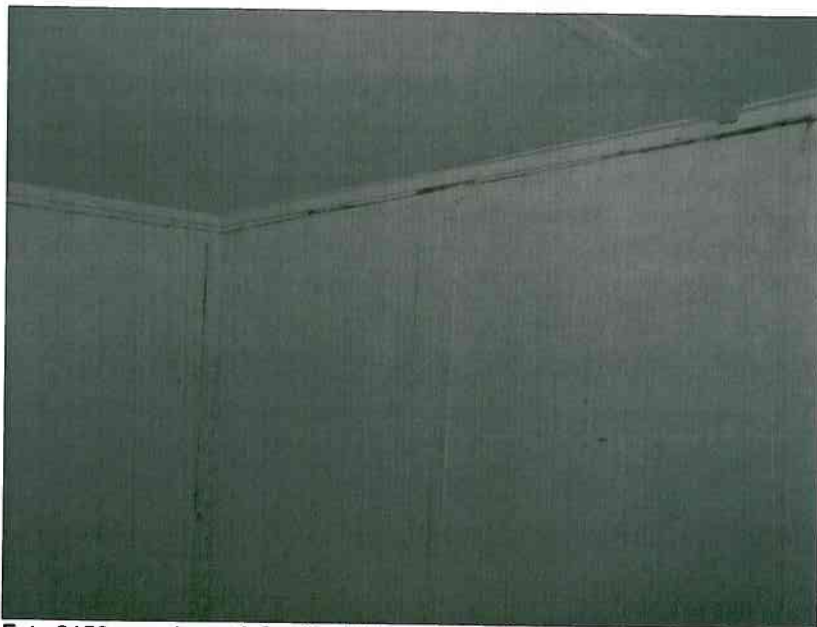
wand- en plafondbeplating in koelcel, paviljoen
